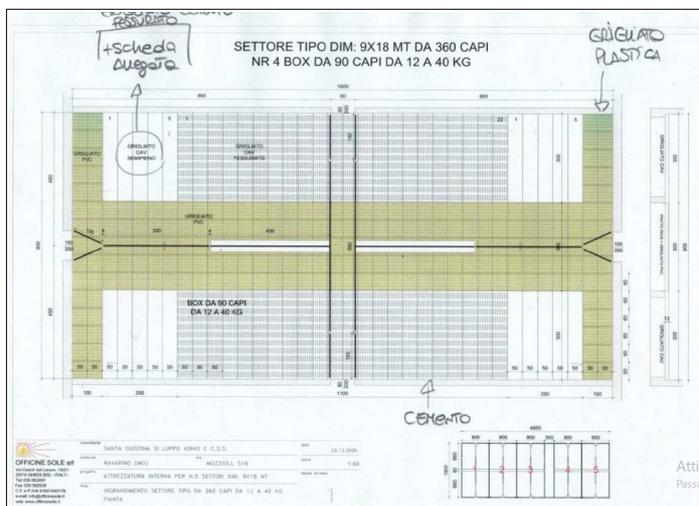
Dettaglio pavimento in CA parzialmente fessurato
